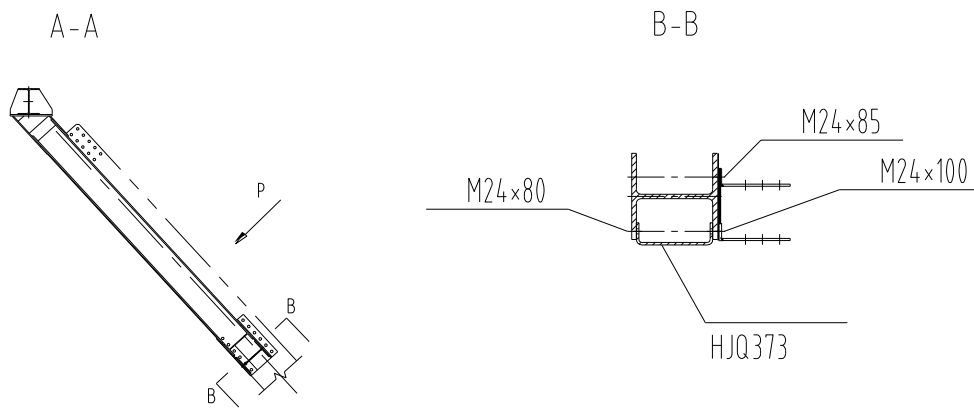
Detalle para la conexión de la entrada de 81.9m y 100.1m b
